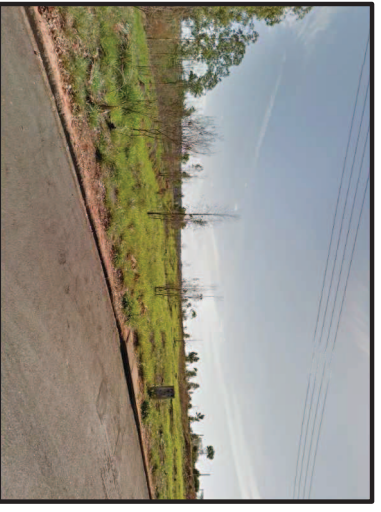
Rua Elisa Prestes César (Pg. Mediterrâneo)
